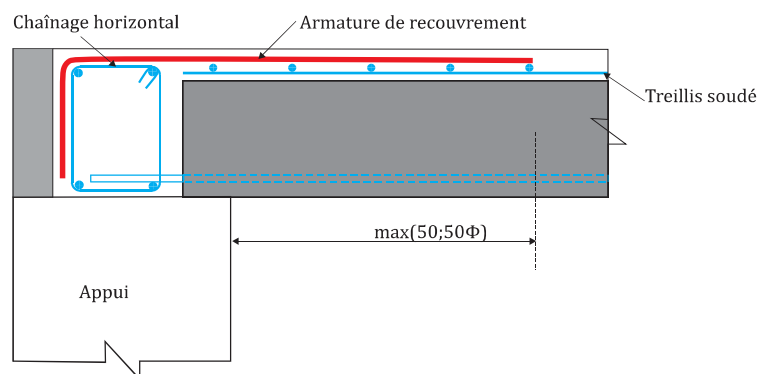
Dispositions des armatures de recouvrement du plancher
